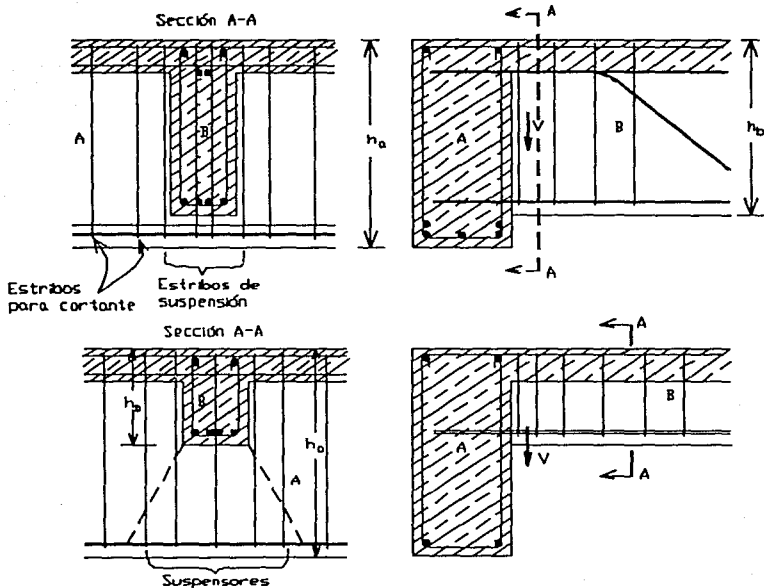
Los estribos de suspensión reciben las reacciones de la viga secundaria. (1.1)
